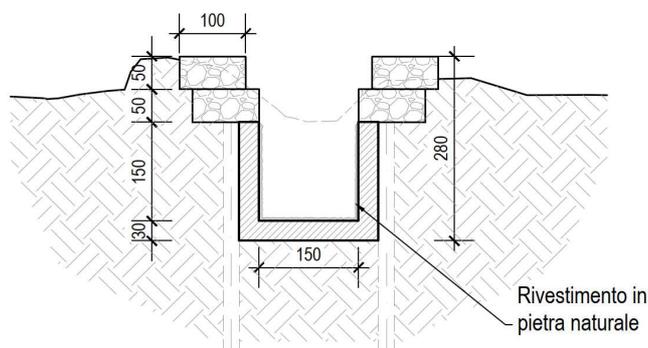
Sezioni intervento di sistemazione idraulica a monte dell'attraversamento 2.
